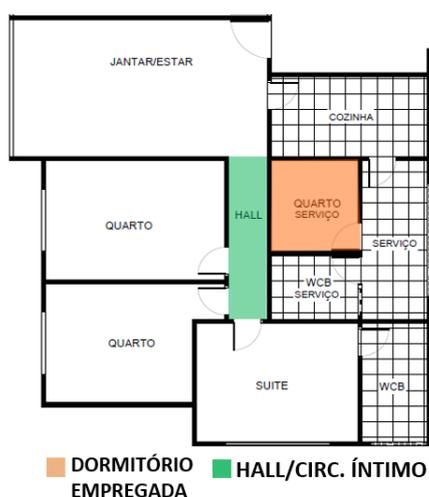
Planta baixa de unid. do Edifício Boca da Grota (1979)
